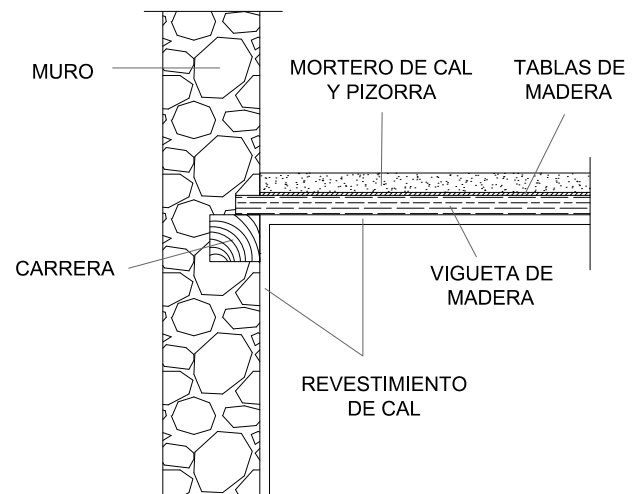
Apoyo de forjado sobre muro. Fuente propia.
